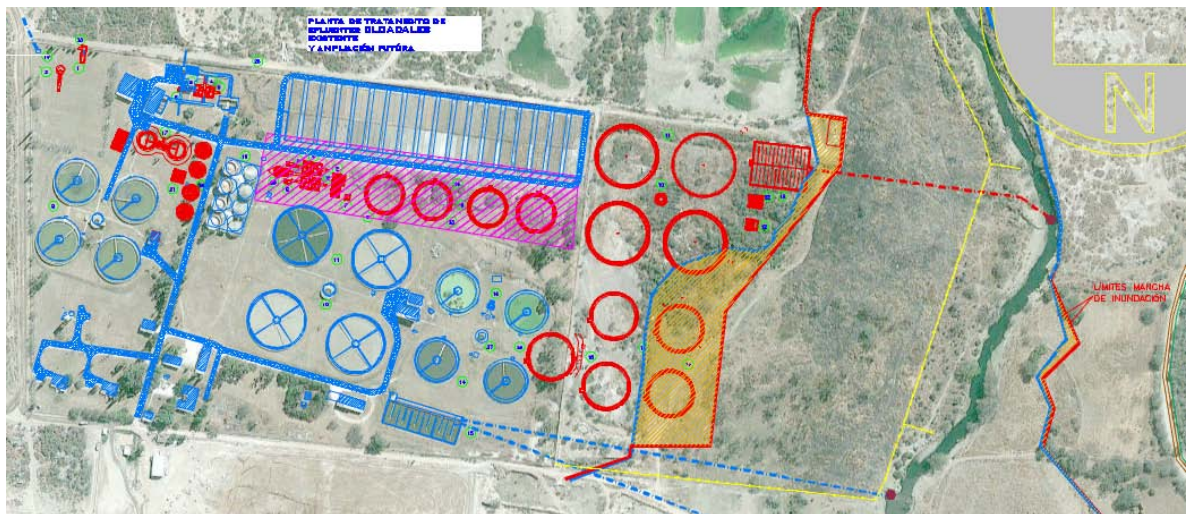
Esquema zona relevada - Sector sur de las playas de secado de barro
